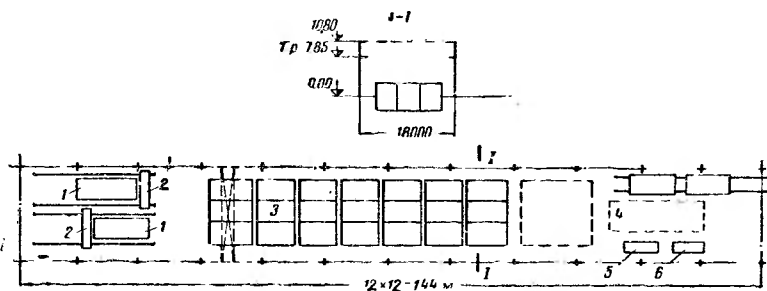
Габаритная схема технологической планировки УТП-1 производства железобетонных конструкций для промышленного строительства (04-09-1)
